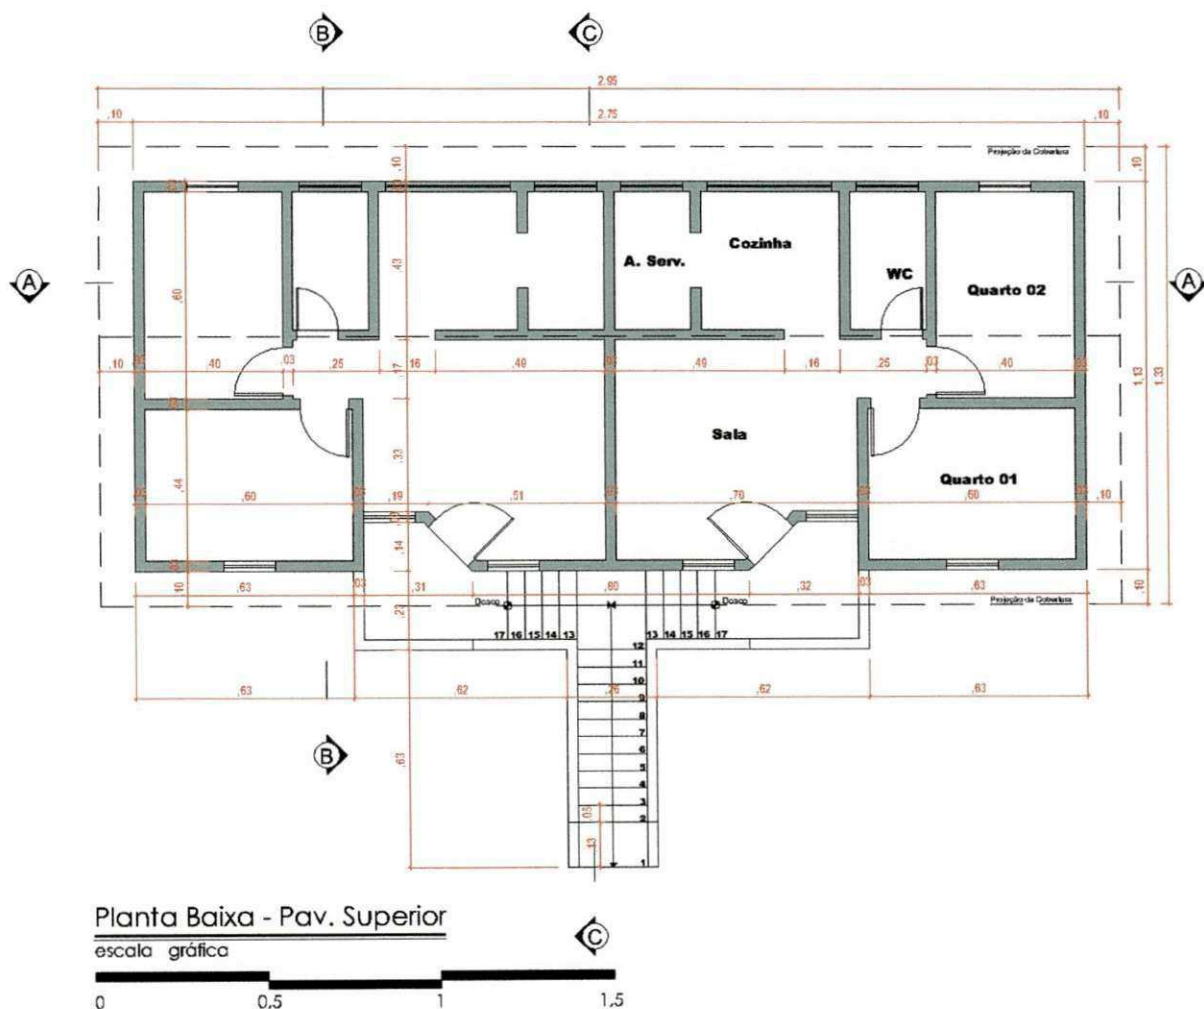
Planta baixa do pavimento superior do modelo reduzido.
